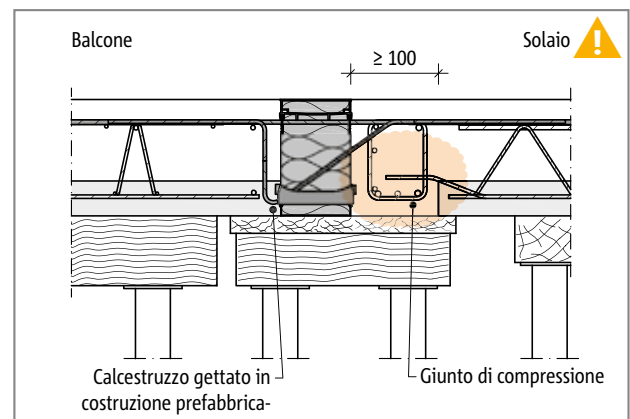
Schöck Isokorb® tipo KXT: appoggio indiretto, montaggio con piastre prefabbricate (qui:  $h \leq 200$  mm), giunto di compressione lato solaio
